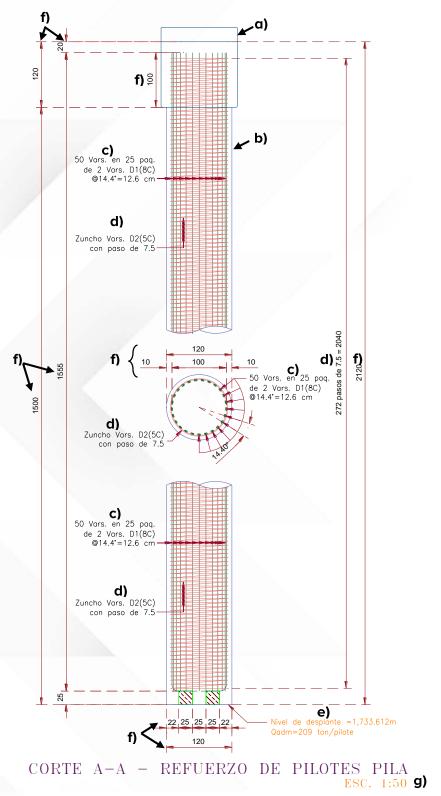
Ejemplo refuerzo de pilotes de pila, corte A-A
